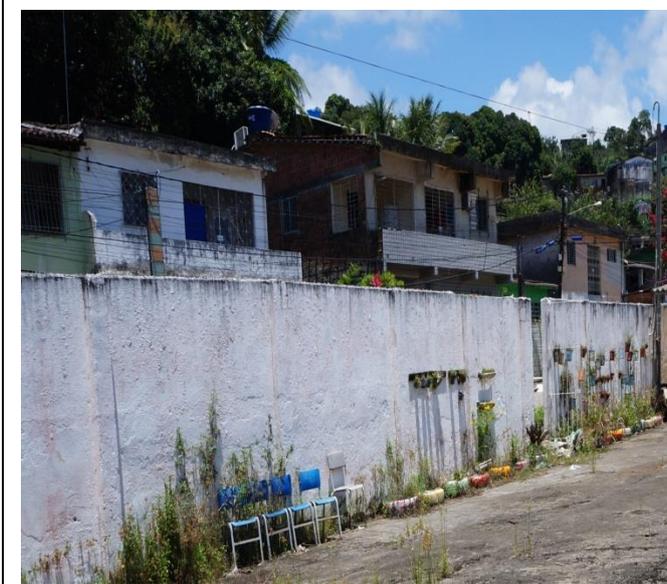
Pintura do muro lado interno e externo em tinta PVA látex.
